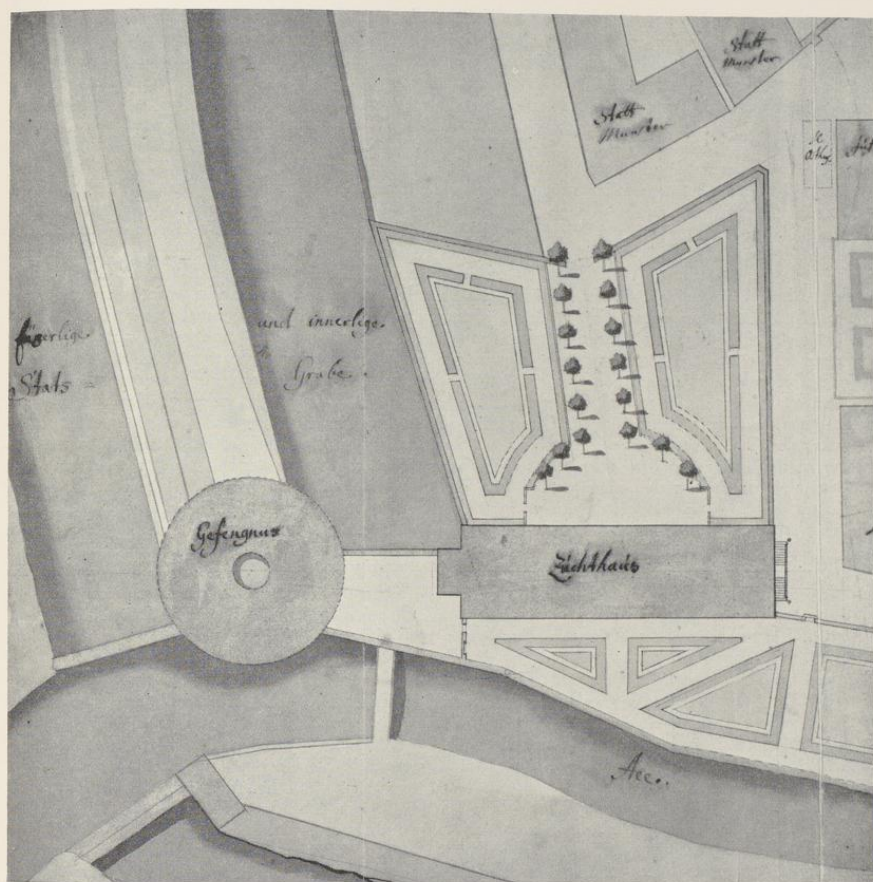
Lageplan des Zuchthauses (erster Entwurf, 1731). Norden unten
